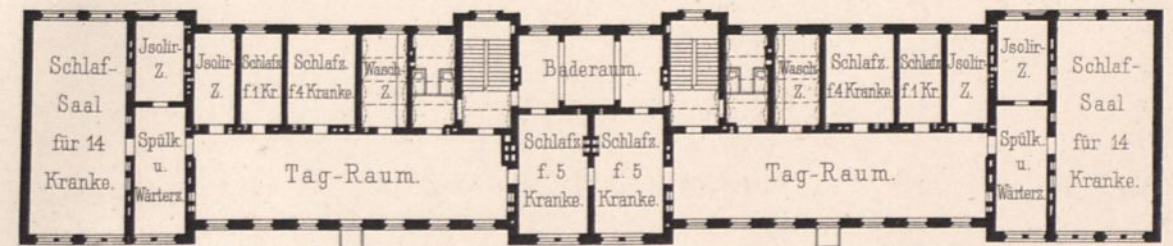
Krankenhaus B. Grundriß des Erdgeschosses.
